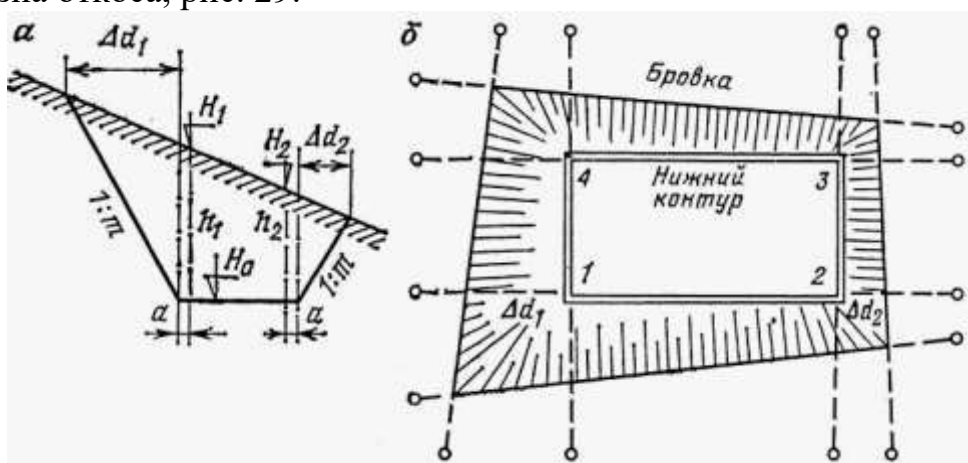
Схема разбивки котлована под фундамента: a – разрез по 1–2; b – план разбивки котлована по нижней и верхней бровкам
